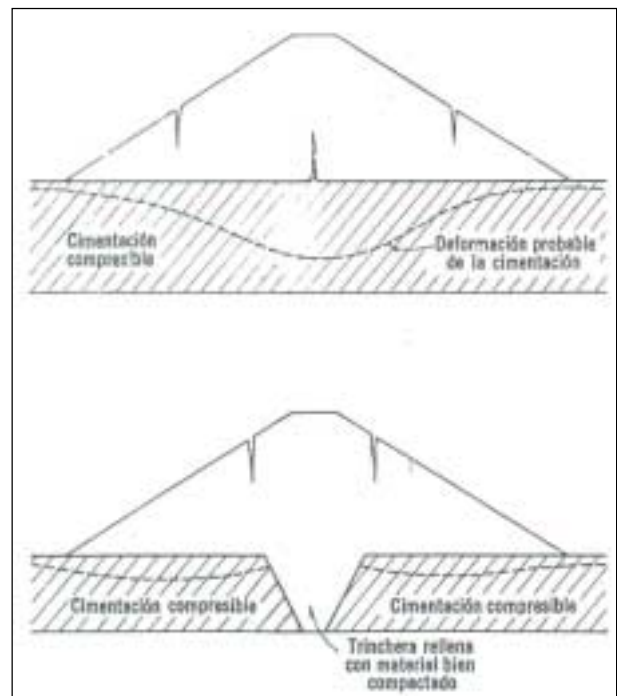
Grietas longitudinales por deformación diferencial de la cimentación.
